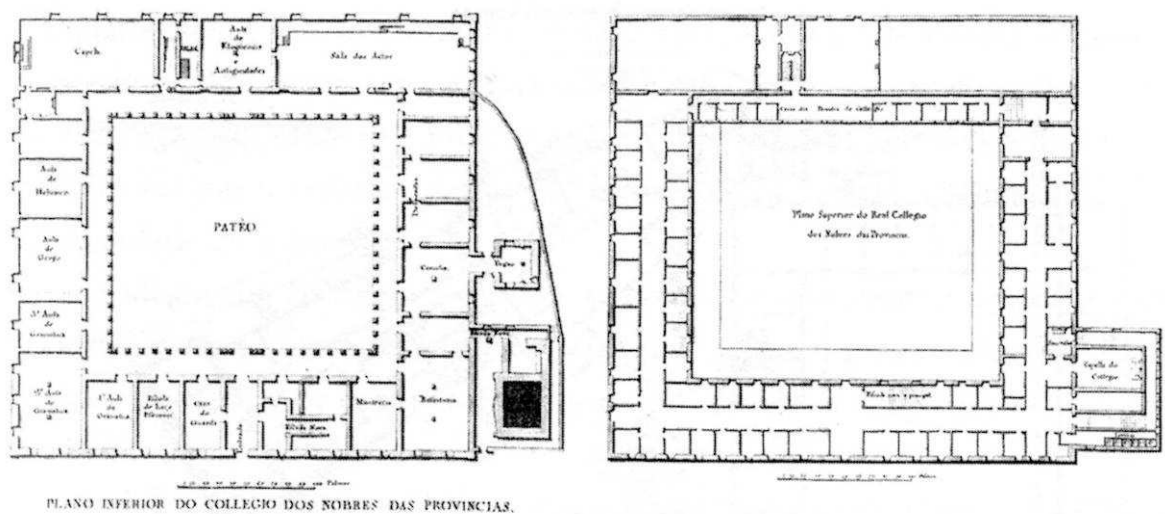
Collegio dos Nobres das Províncias. Plano Inferior e Plano Superior, Guilherme Eldsen (1773)
